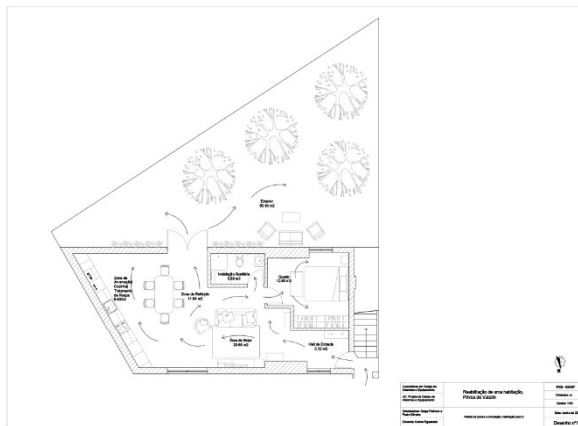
Planta de Circulação Habitação Piso 0. Fonte: Autor.
